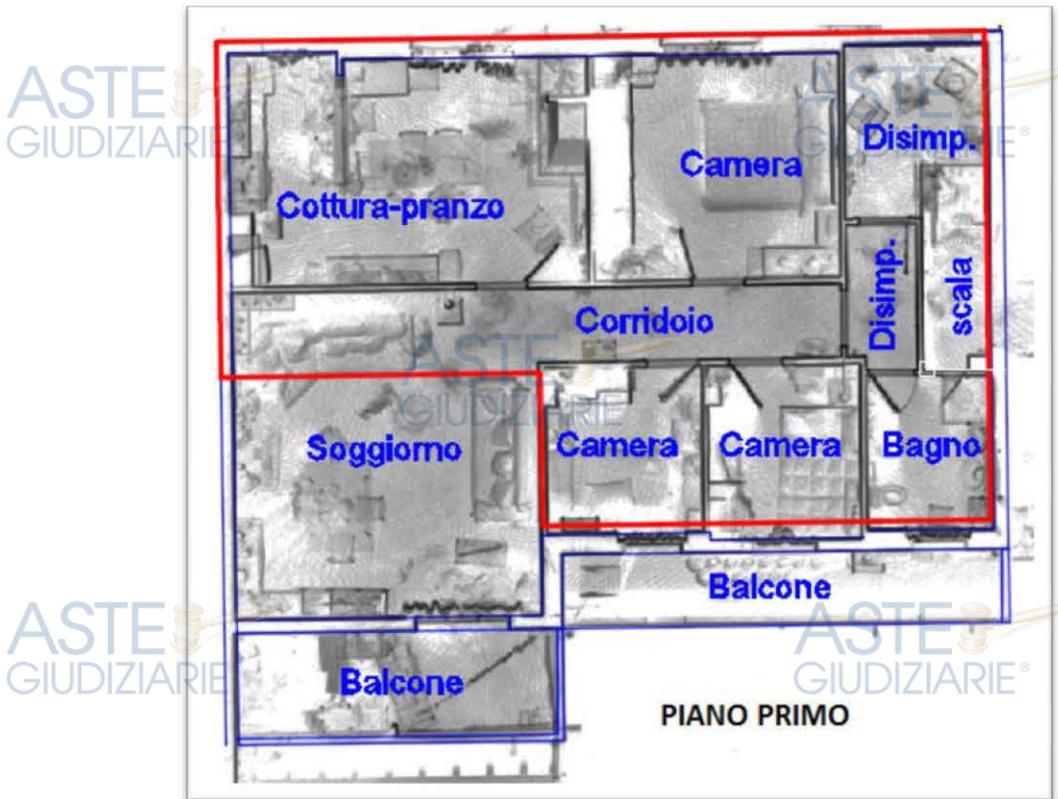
Planimetria stato dei luoghi, in rosso ingombro sedime di progetto.
